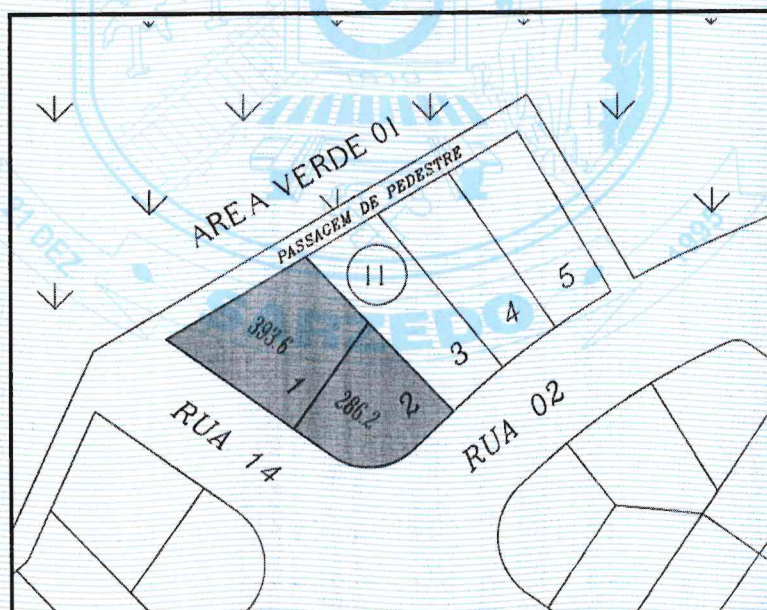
Planta dos lotes 1 e 2 da quadra 11 do Bairro Santa Rosa.
